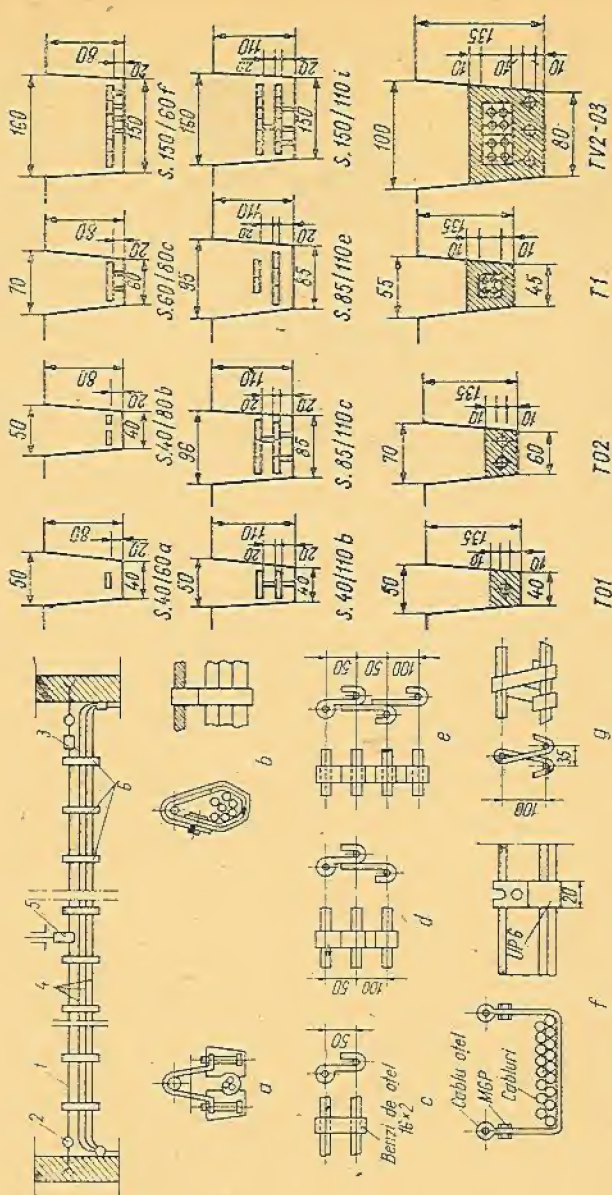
Exemplu de pozarea cablurilor suspendate:
